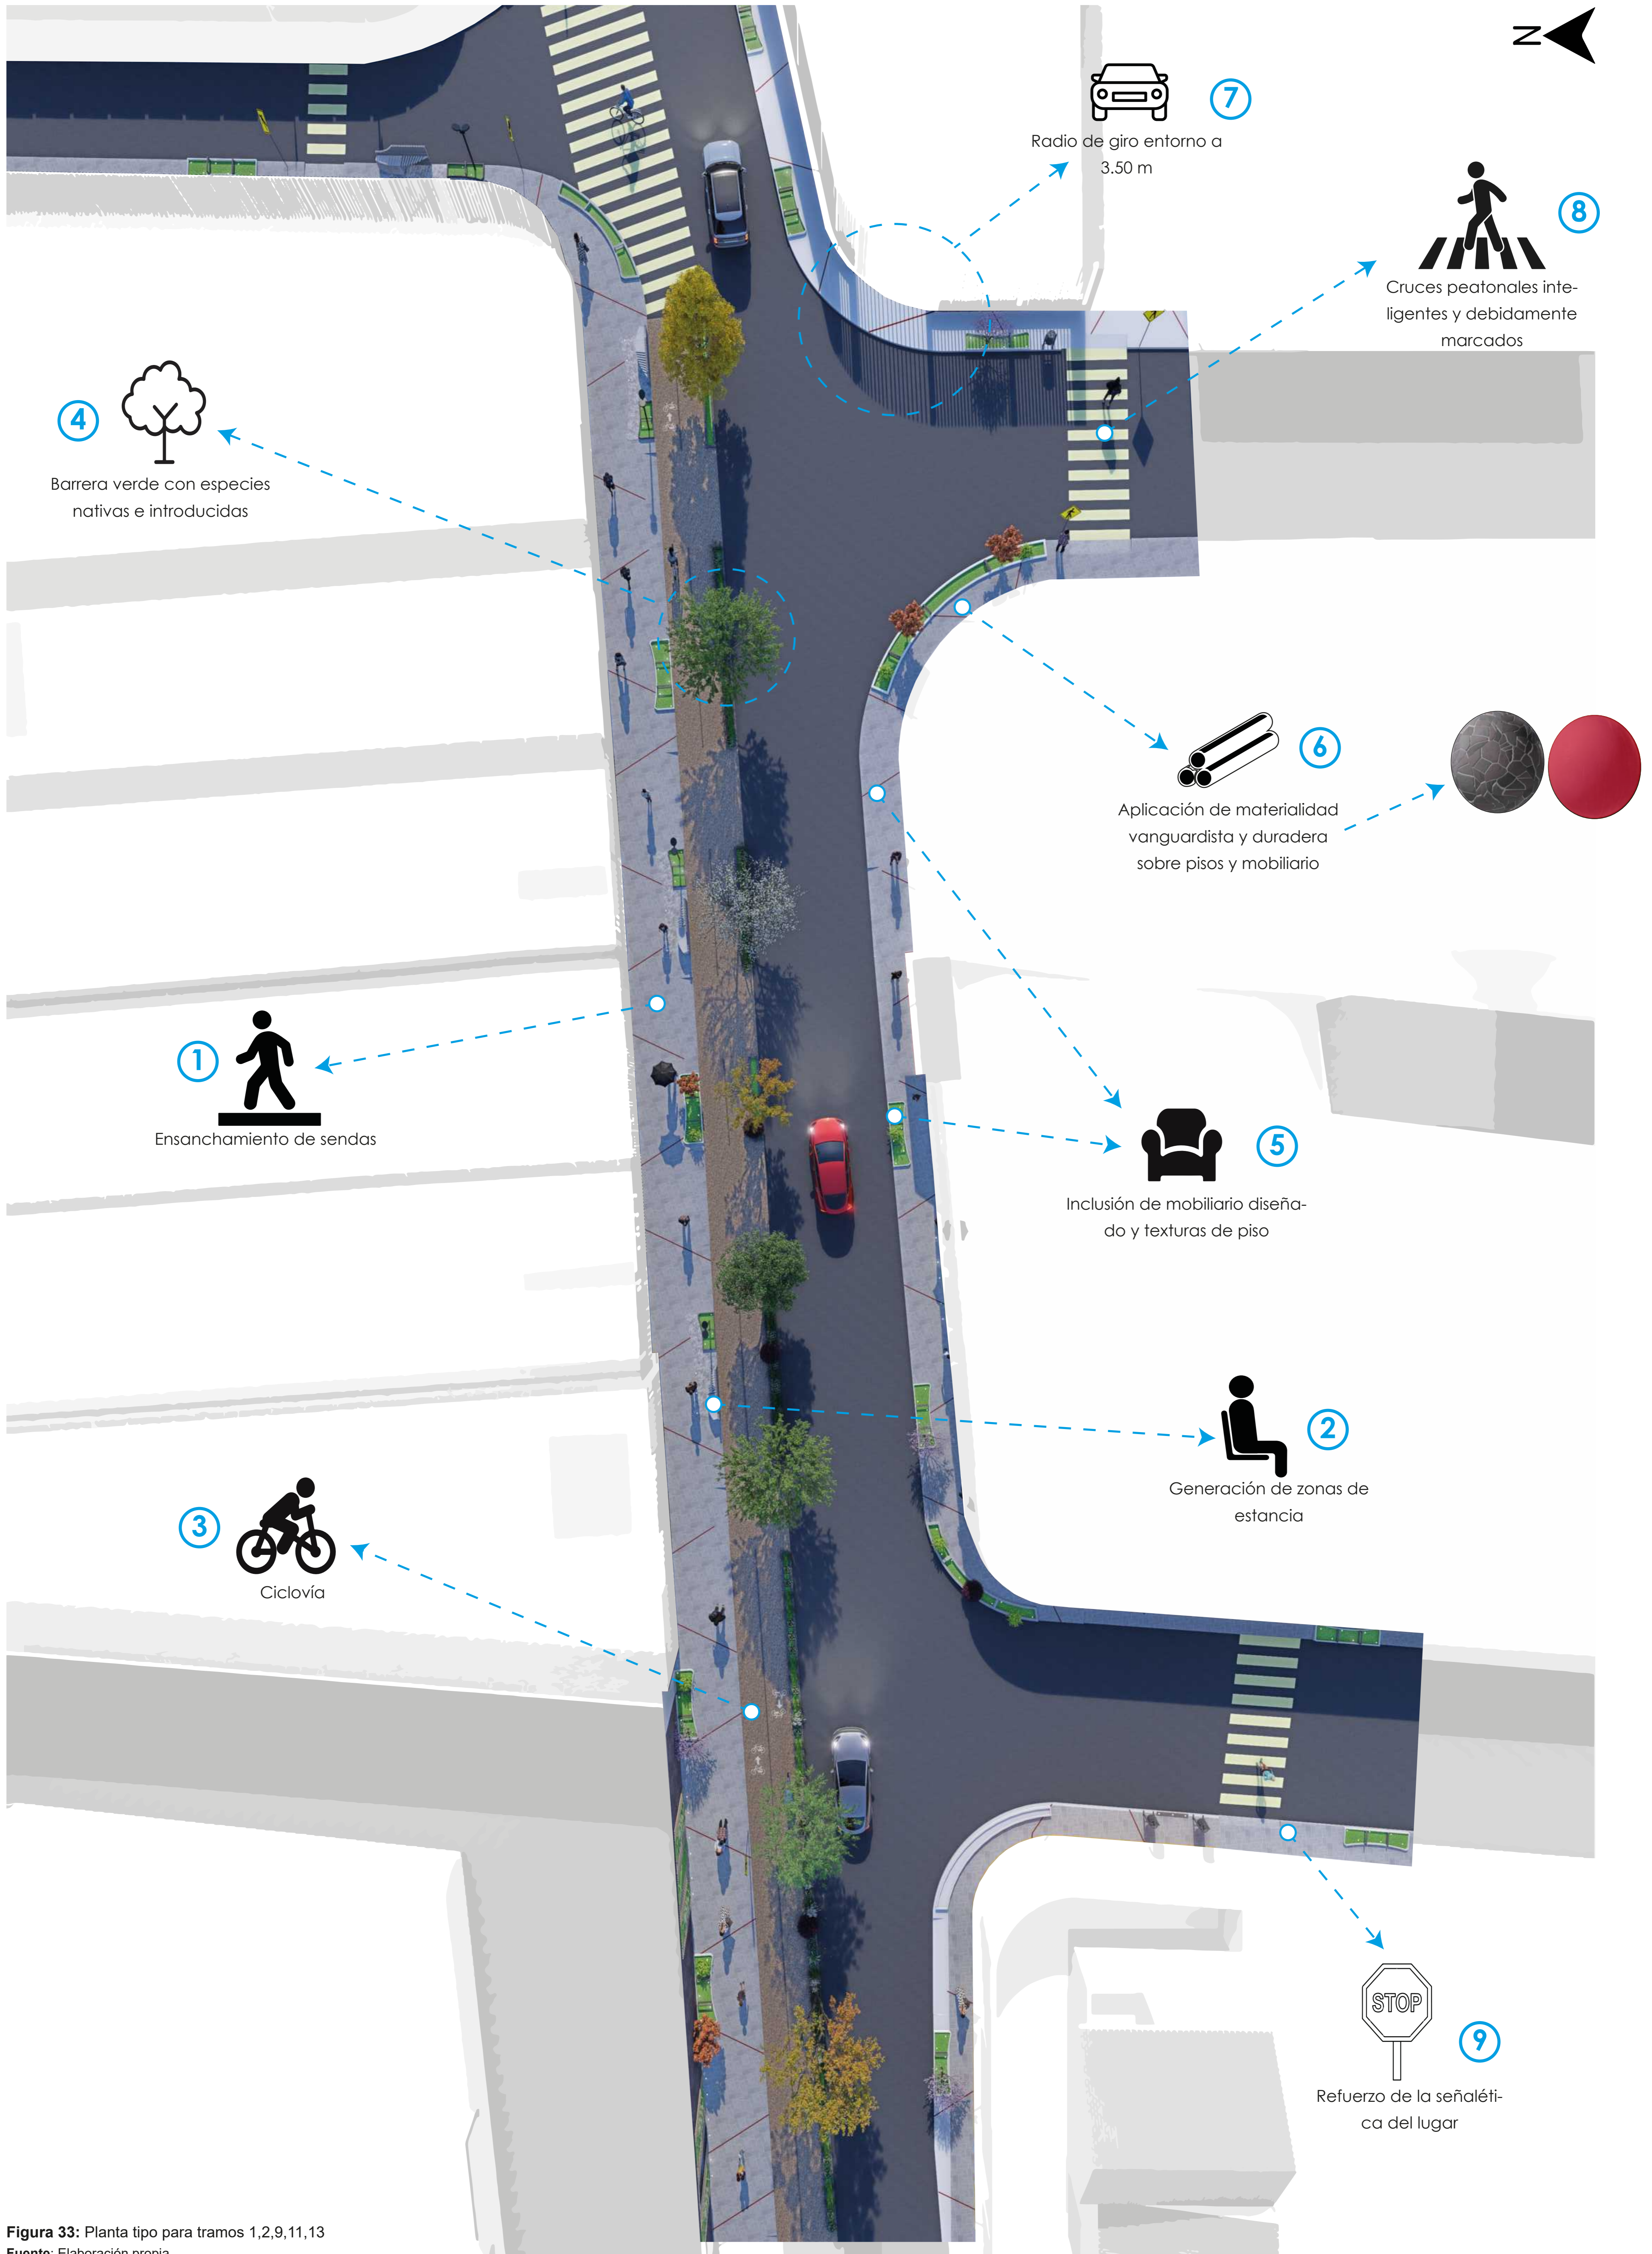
Planta tipo para tramos 1,2,9,11,13
